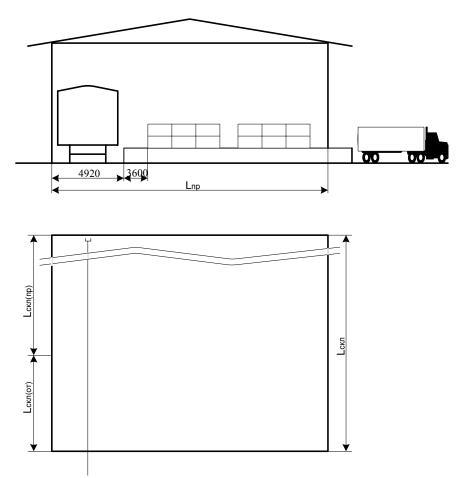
Поперечный разрез и план крытого склада из железобетонных конструкций
